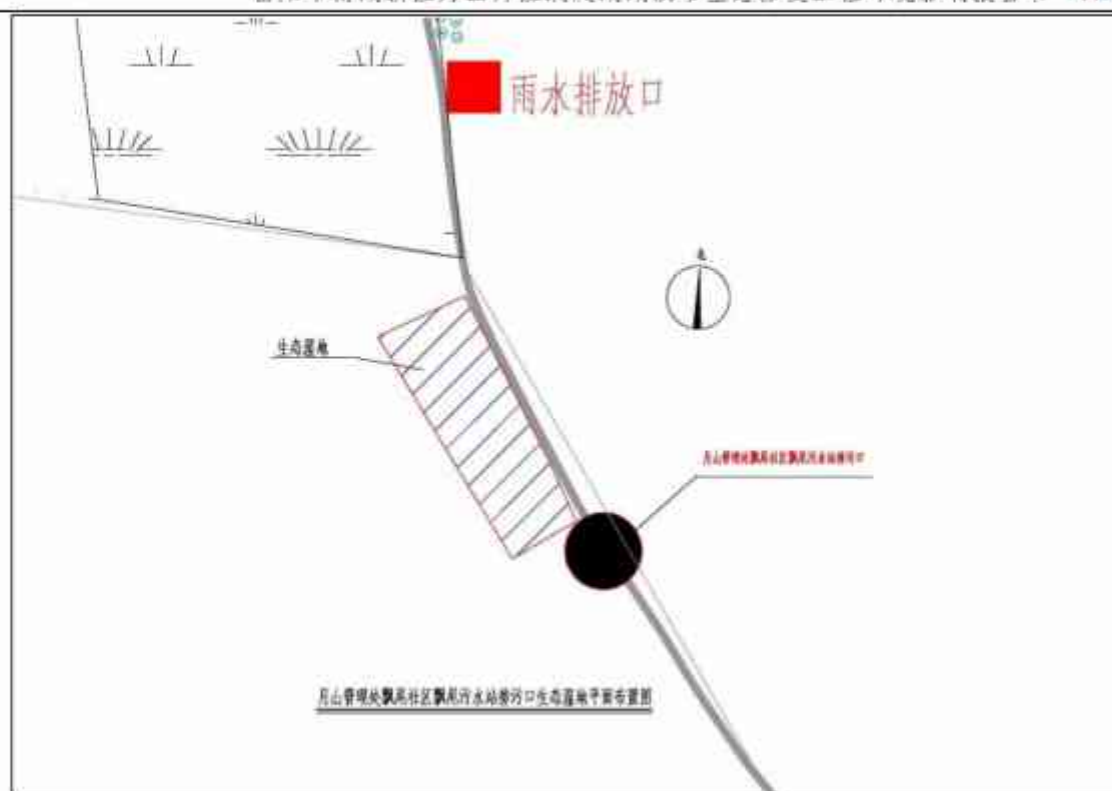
排污口平面布置图三（飘尾污水站排污口）
